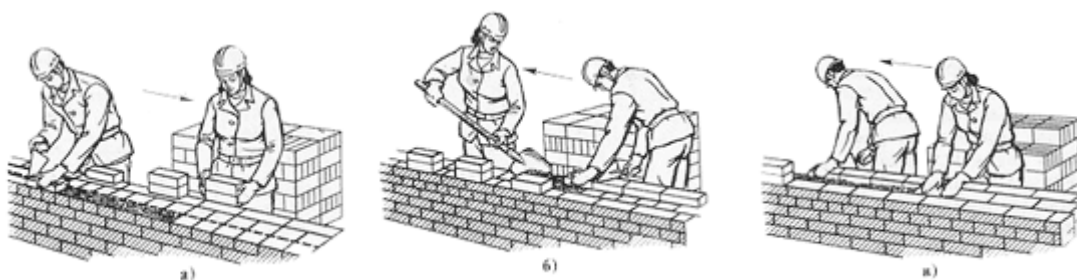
Кладка стены толщиной звеном "двойка":
